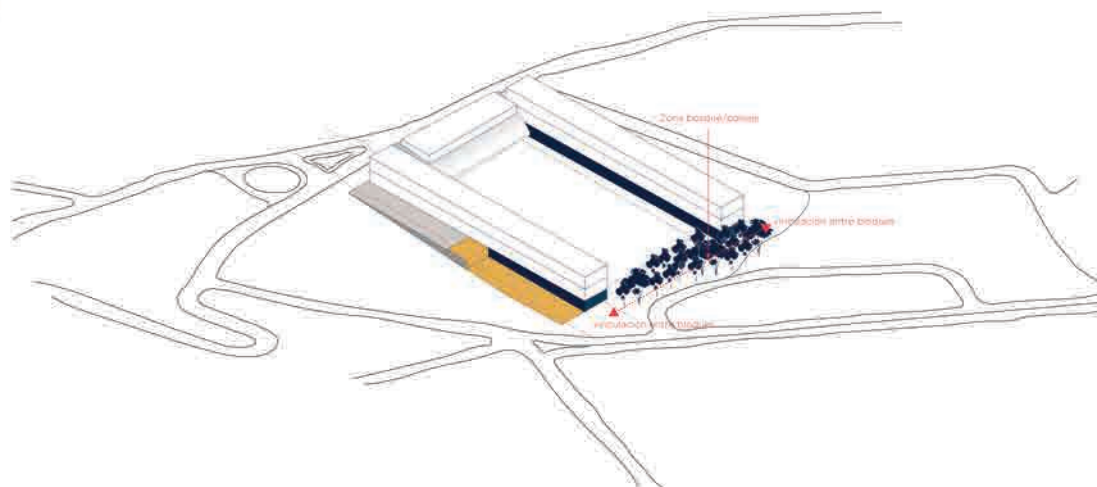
Implantación de vegetación. Elaboración: Autores.
